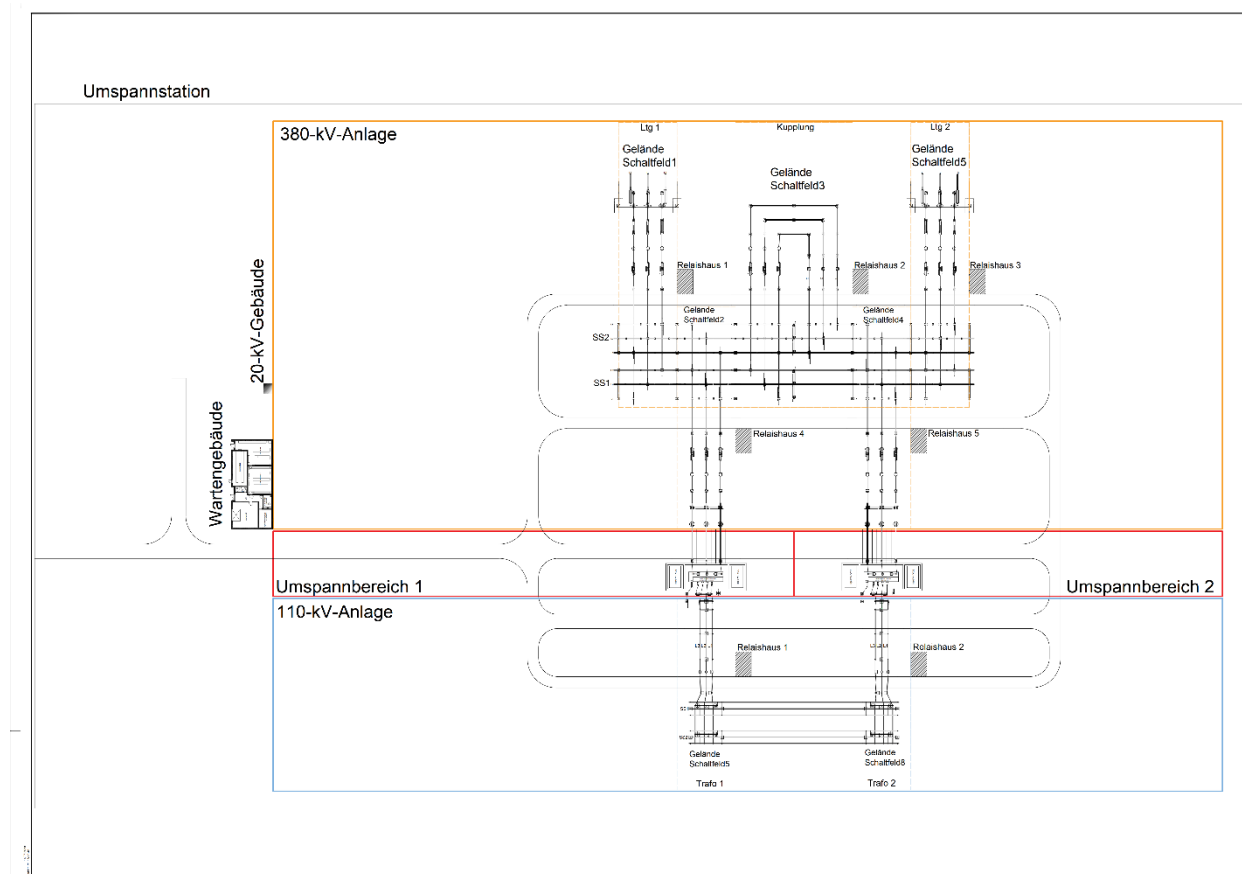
Beispiel einer Umspannstation – Grundriss
